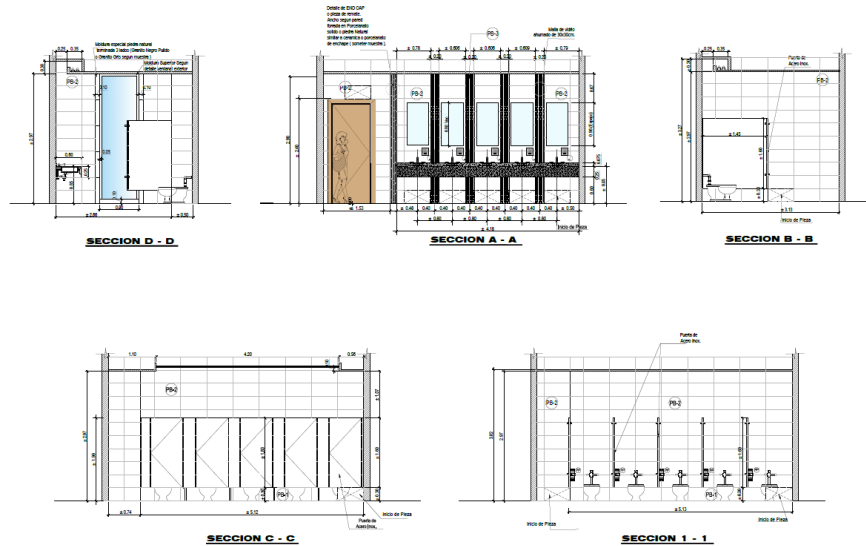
Elevaciones y corte interior baño damas de torre 3
